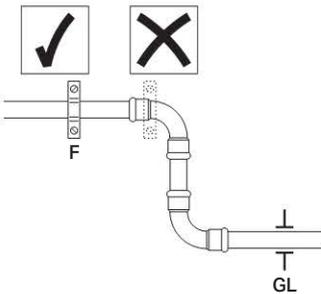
Placement des points fixes: sur la conduite, et non pas sur le raccord à presser
